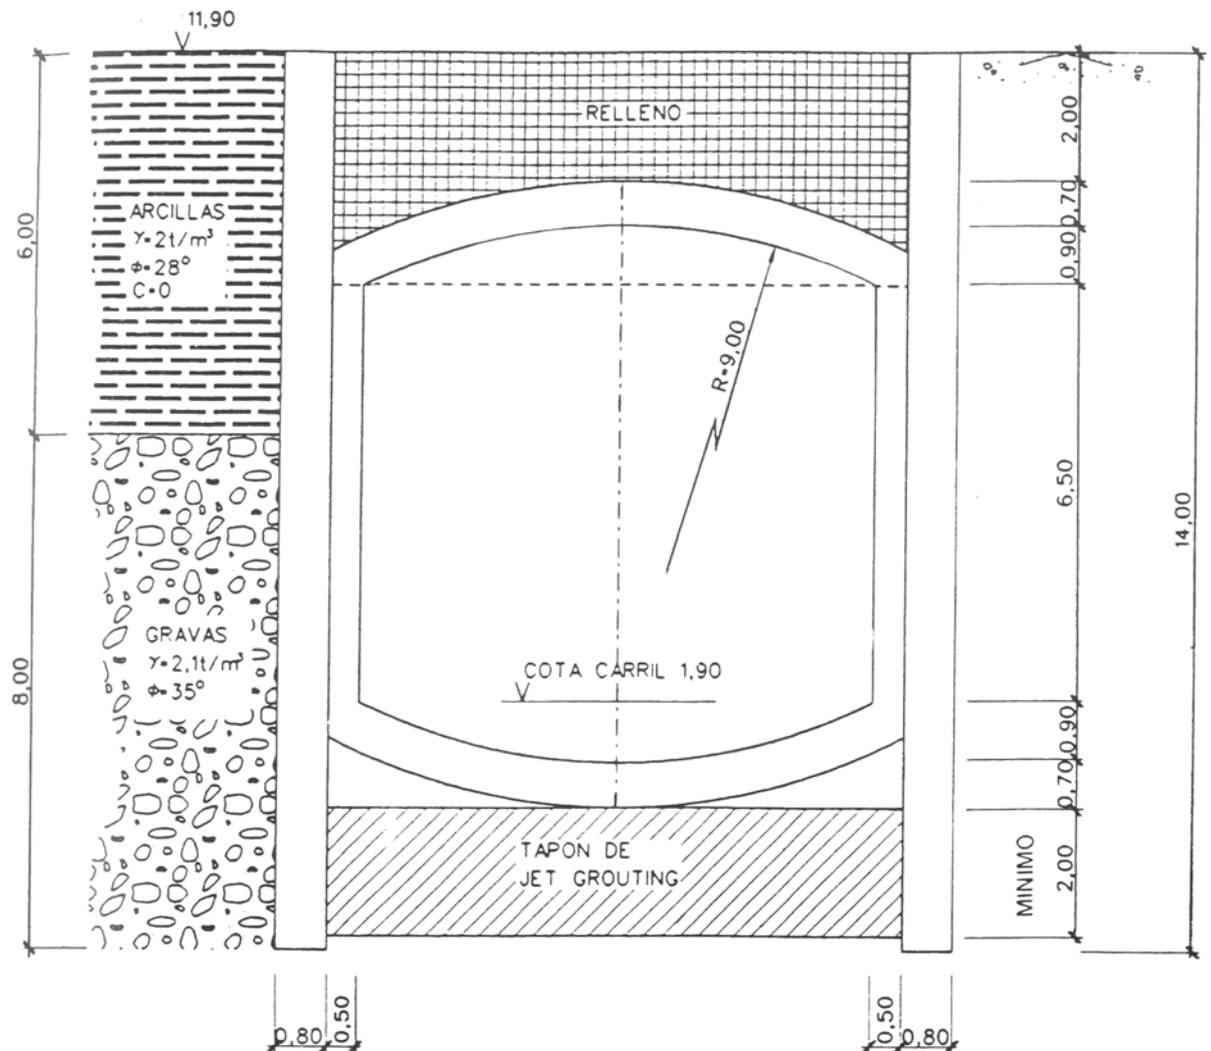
Ejemplo de aplicación de tapón de jet grouting para la ejecución de un túnel de metro (sistema cut and cover)
